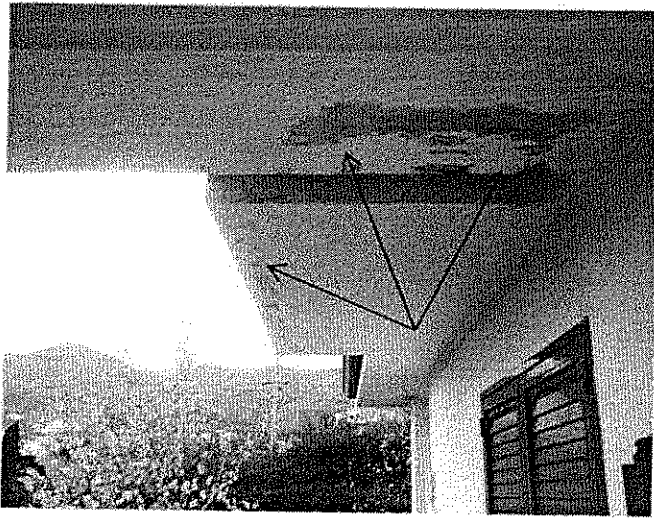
e 20 - Particolare inizio degrado di un Soffitto esterno.
